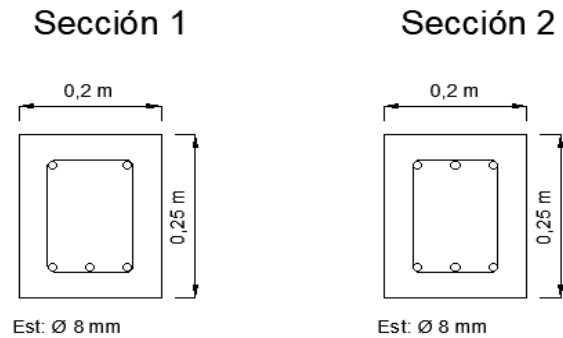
Diseño de viga. Vista frontal [Autores]
